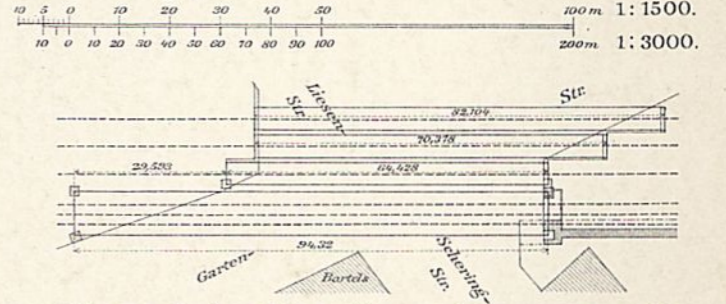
Lageplan d. Unterführung d. Liesenstr. 1: 1500.
